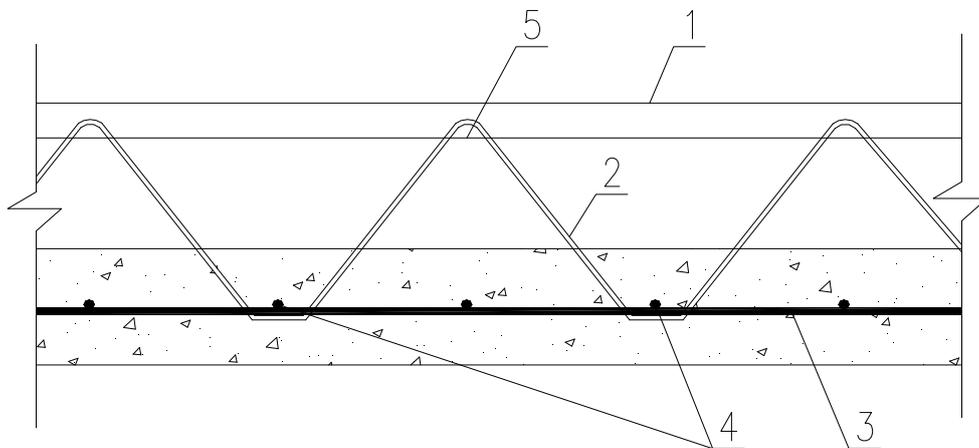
吊点位置横向附加钢筋与预制底板内钢筋位置关系示意
